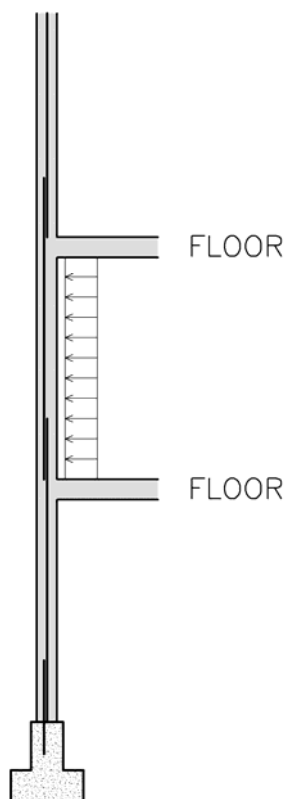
Azioni flettenti applicate fuori dal piano delle pareti
